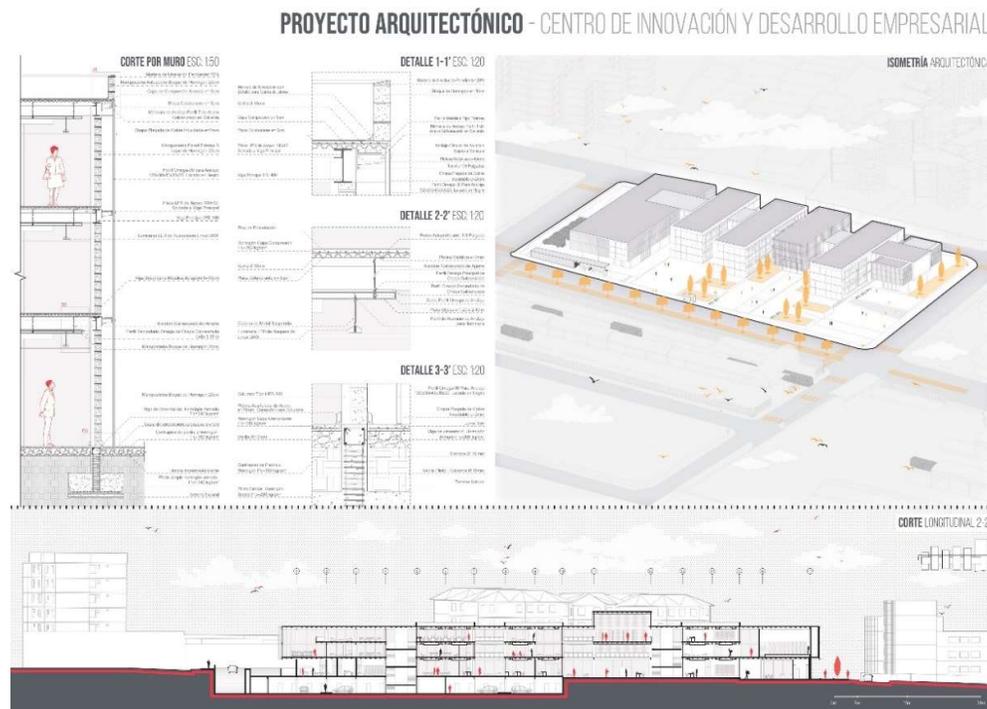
Detalles arquitectónicos, Isometría y Corte longitudinal. Elaborado por: Andrés
